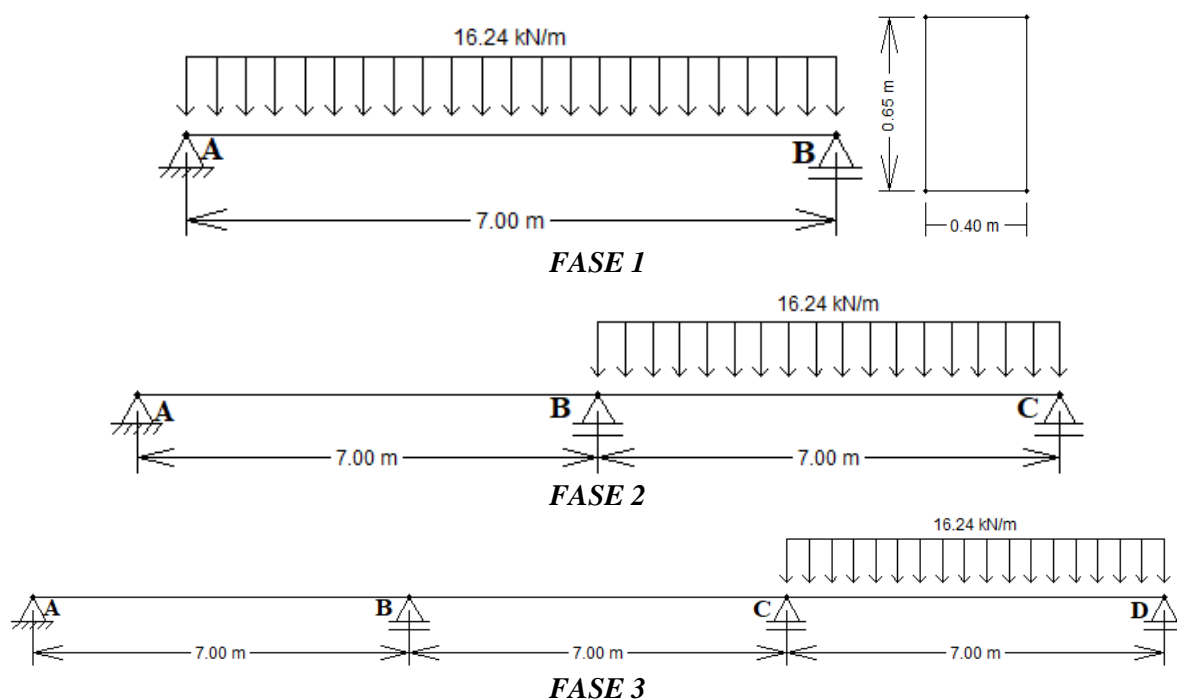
Faseamento longitudinal da viga de concreto.
